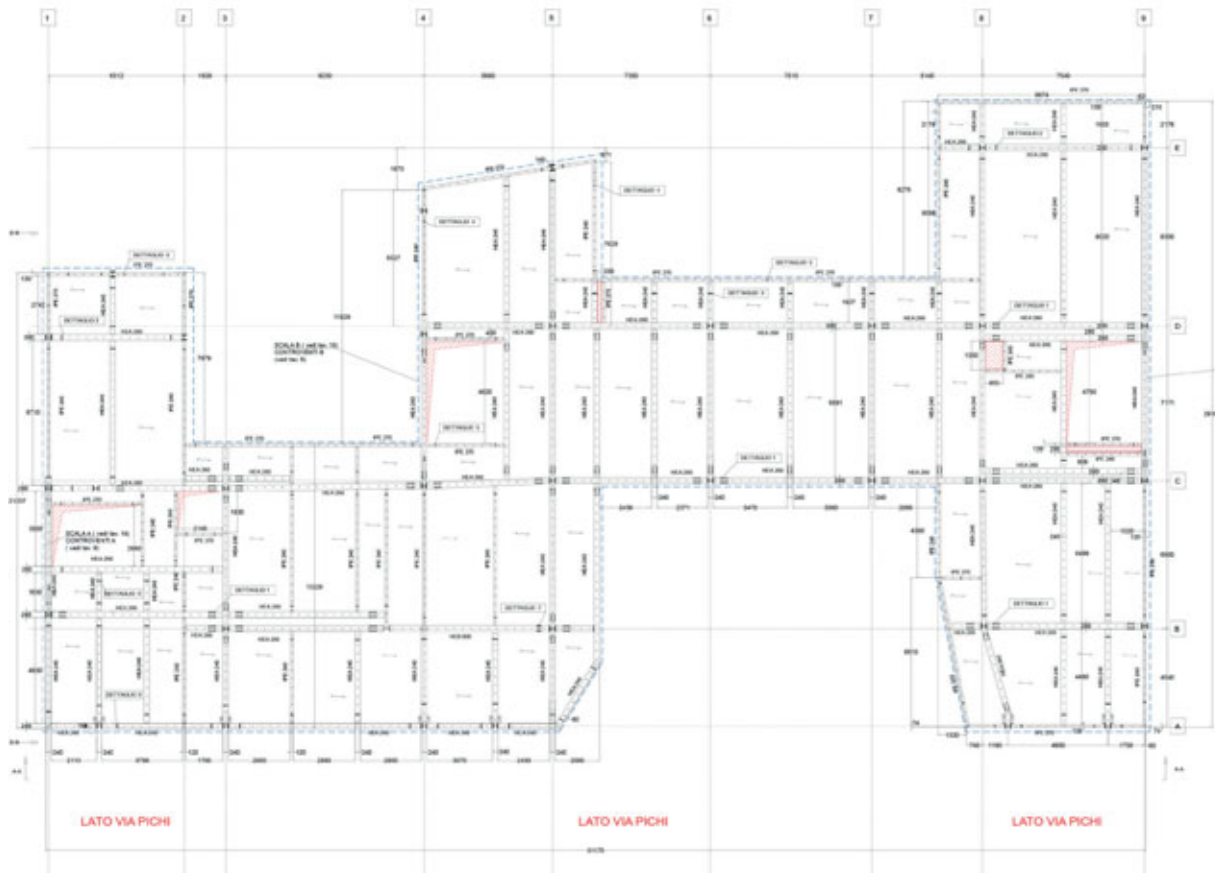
Orditura travi e andamento dei solai, piano primo, edificio Pichi 12. © Carpenteria S.A.C.I.F. Srl
